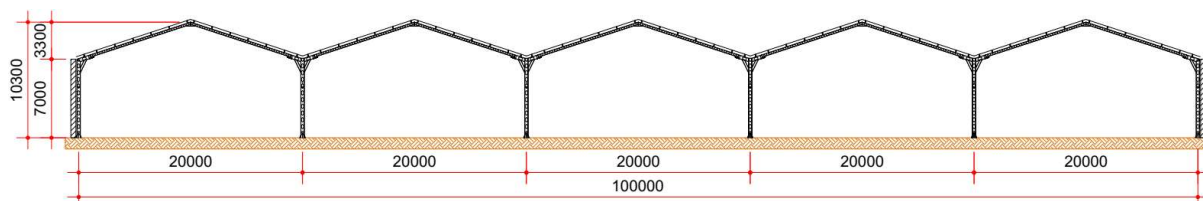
ESQUEMA DOS PÓRTICOS (DIMENSÕES EM MM)
